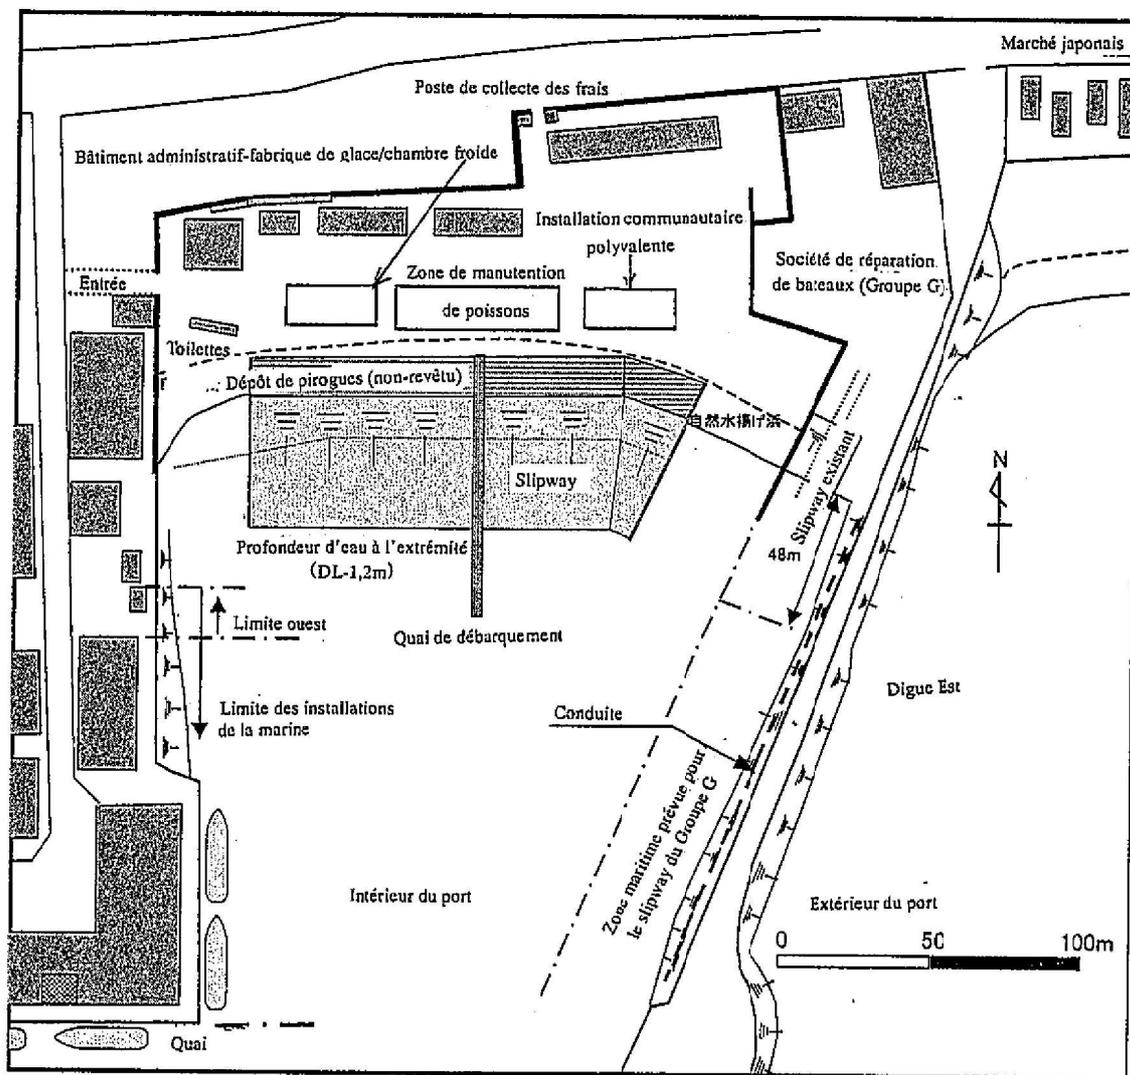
Plan de disposition des installations de génie civil
